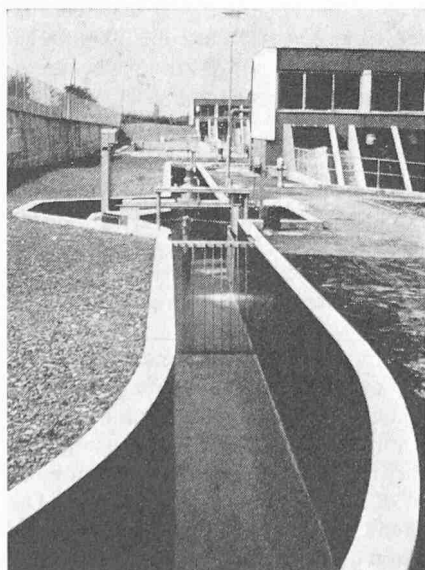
EP-Beschichtung in einer Trinkwasserfassung
